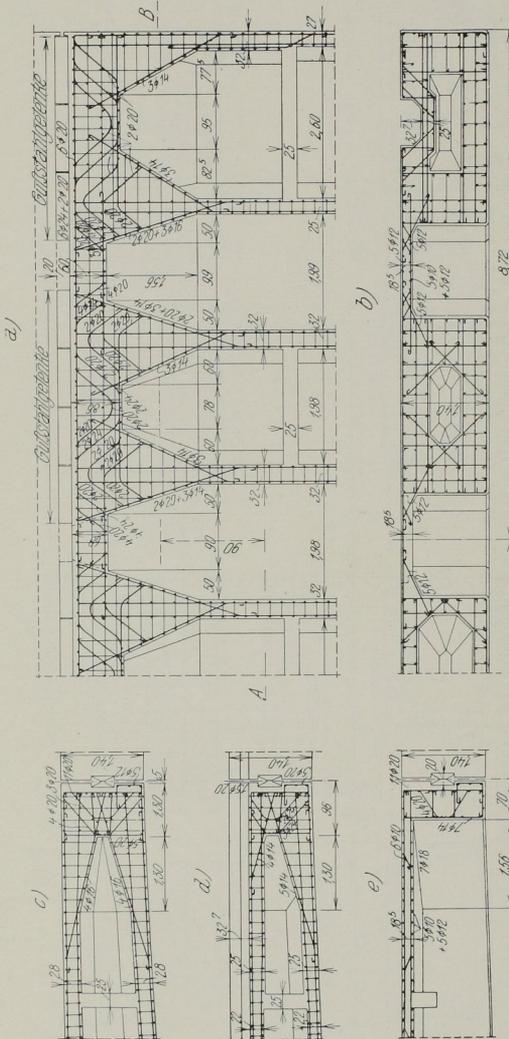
Bewehrung des Druckhauptes am Scheitel, im Grundriß a), Querschnitt b) und 3 Längsschnitten c) d) e)
